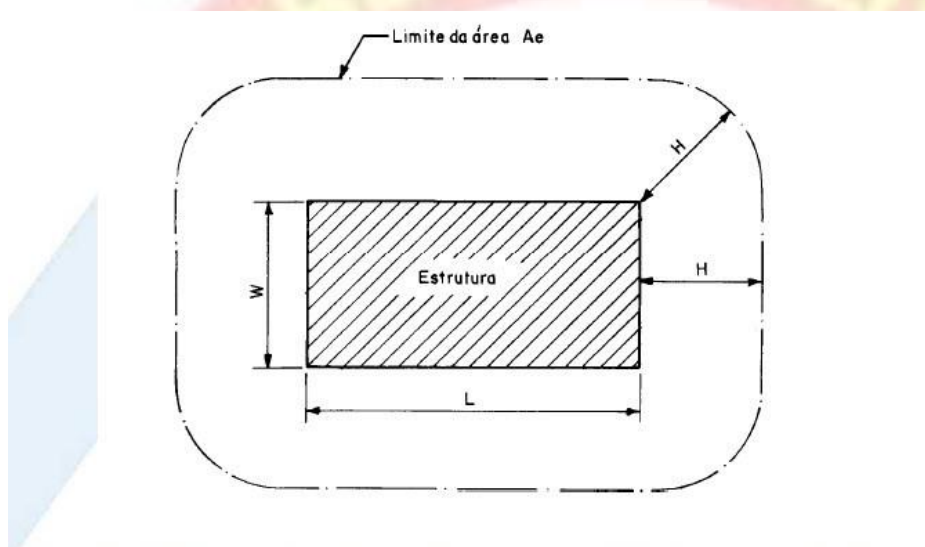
Delimitação da área de exposição equivalente (A_e) - Estrutura vista de planta
